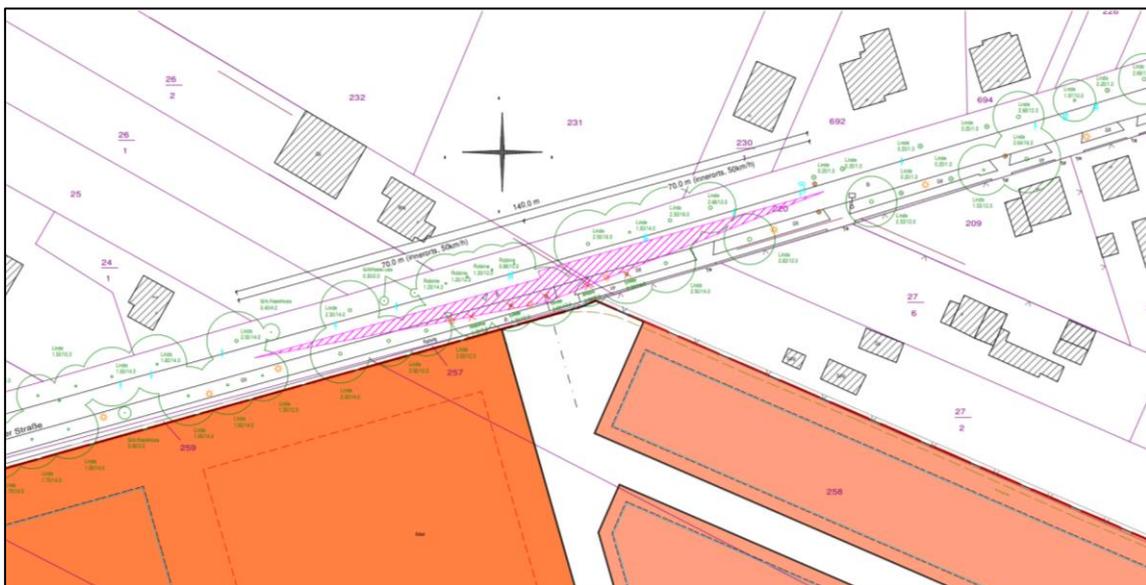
Ausschnitt Lageplan mit Sichtdreiecken zum Fällantrag, Haßmann & Kaula, 14.12.2020
